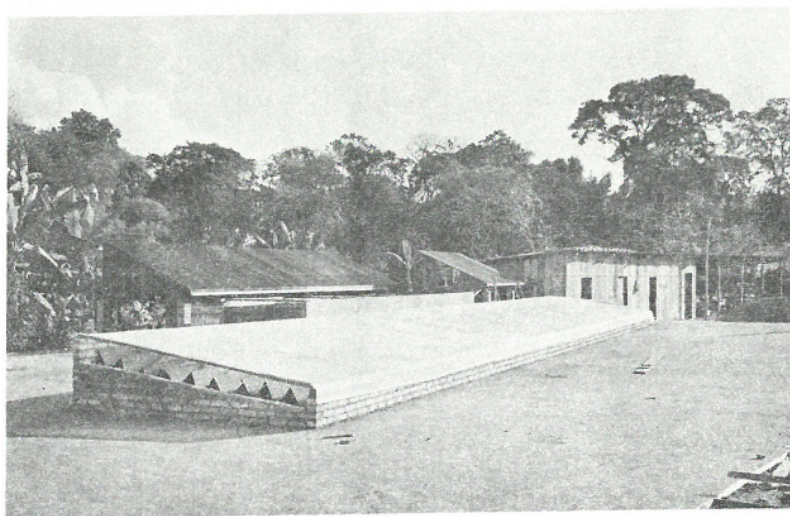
Vista do conjunto. No primeiro plano, o acumulador de calor e, atrás dele, o secador.
